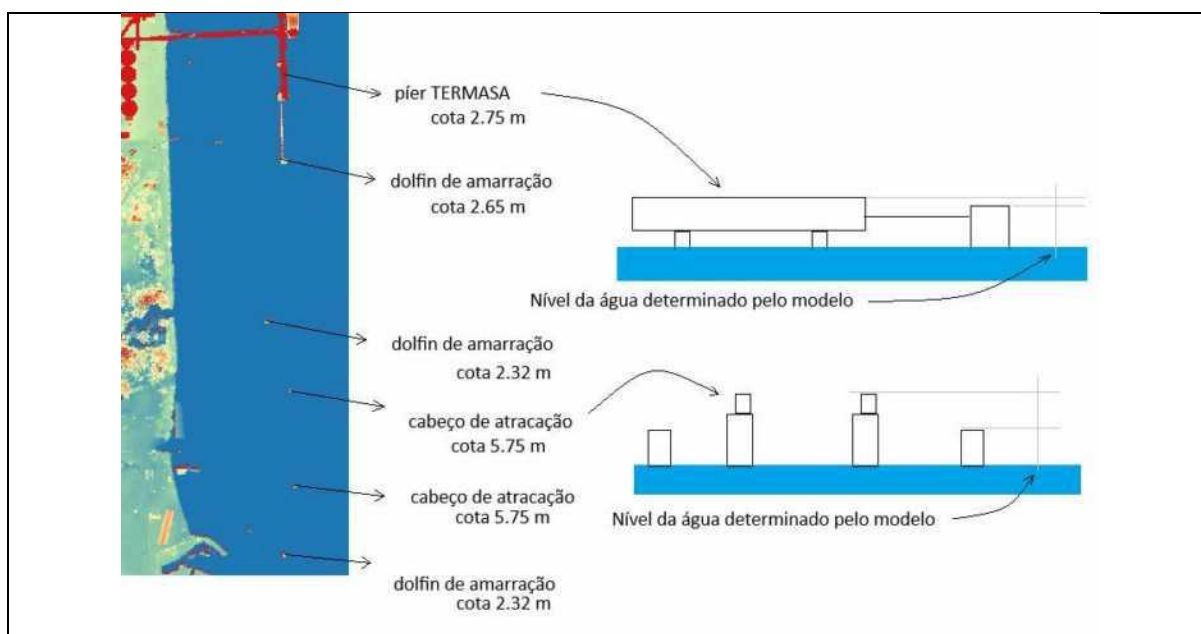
Detalhamento da aplicação do modelo para cálculo de cotas de segurança em elementos críticos da estrutura portuária.
